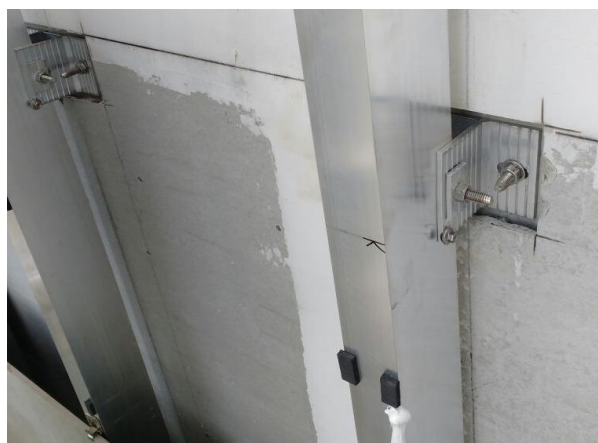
Fixação cantoneiras elevação substrato *drywall
